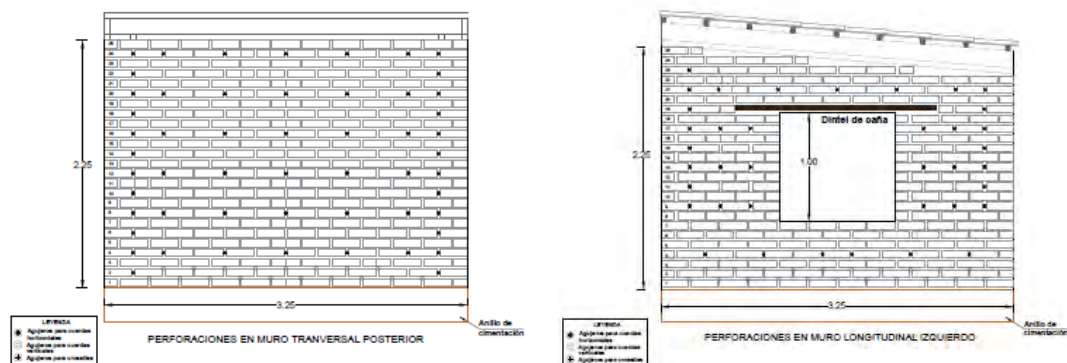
Plano de perforaciones para cuerdas de refuerzo
